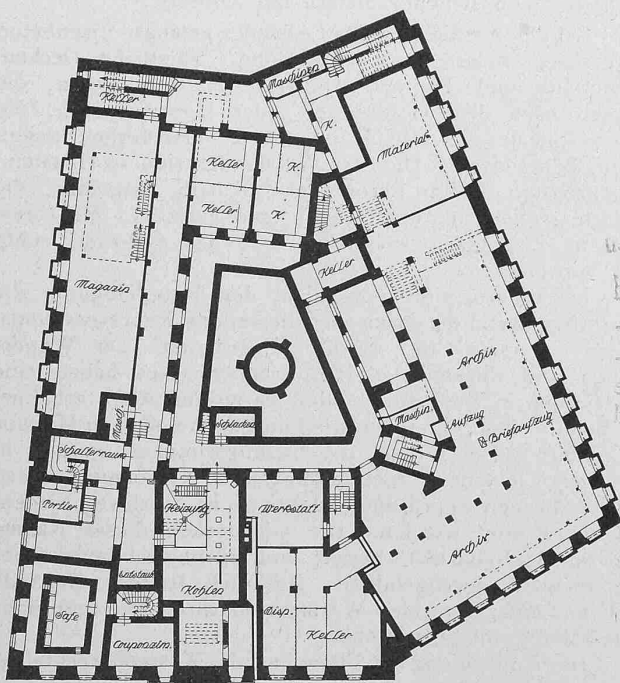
Grundriss vom Untergeschoss. — 1:600.
